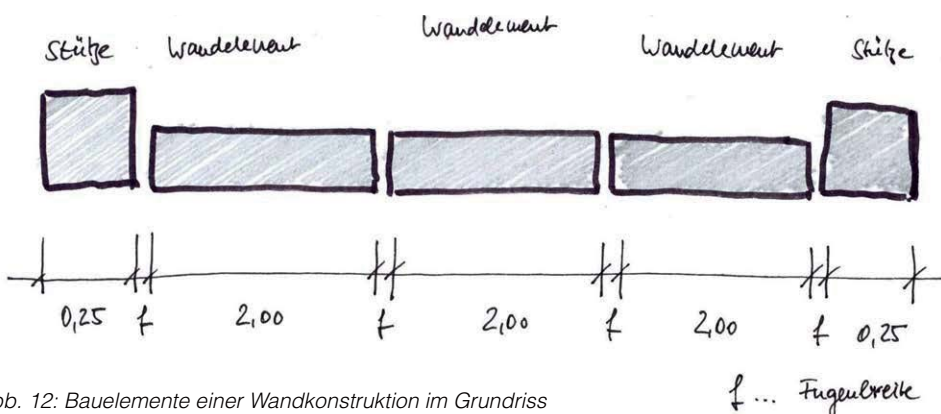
Bauelemente einer Wandkonstruktion im Grundriss
